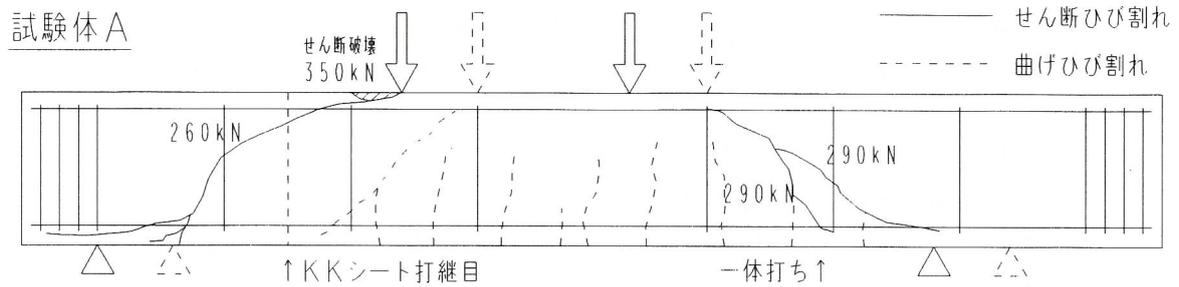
ひび割れ状況 (試験体 A)
